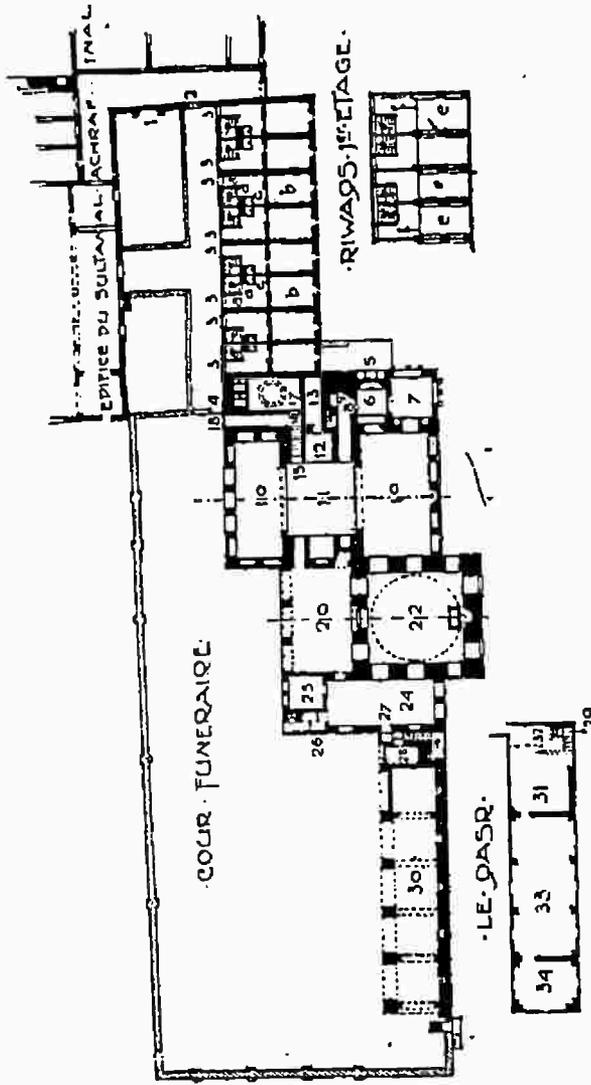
مسقط أفقي لقبة طراباي الشريفى بباب الوزير
